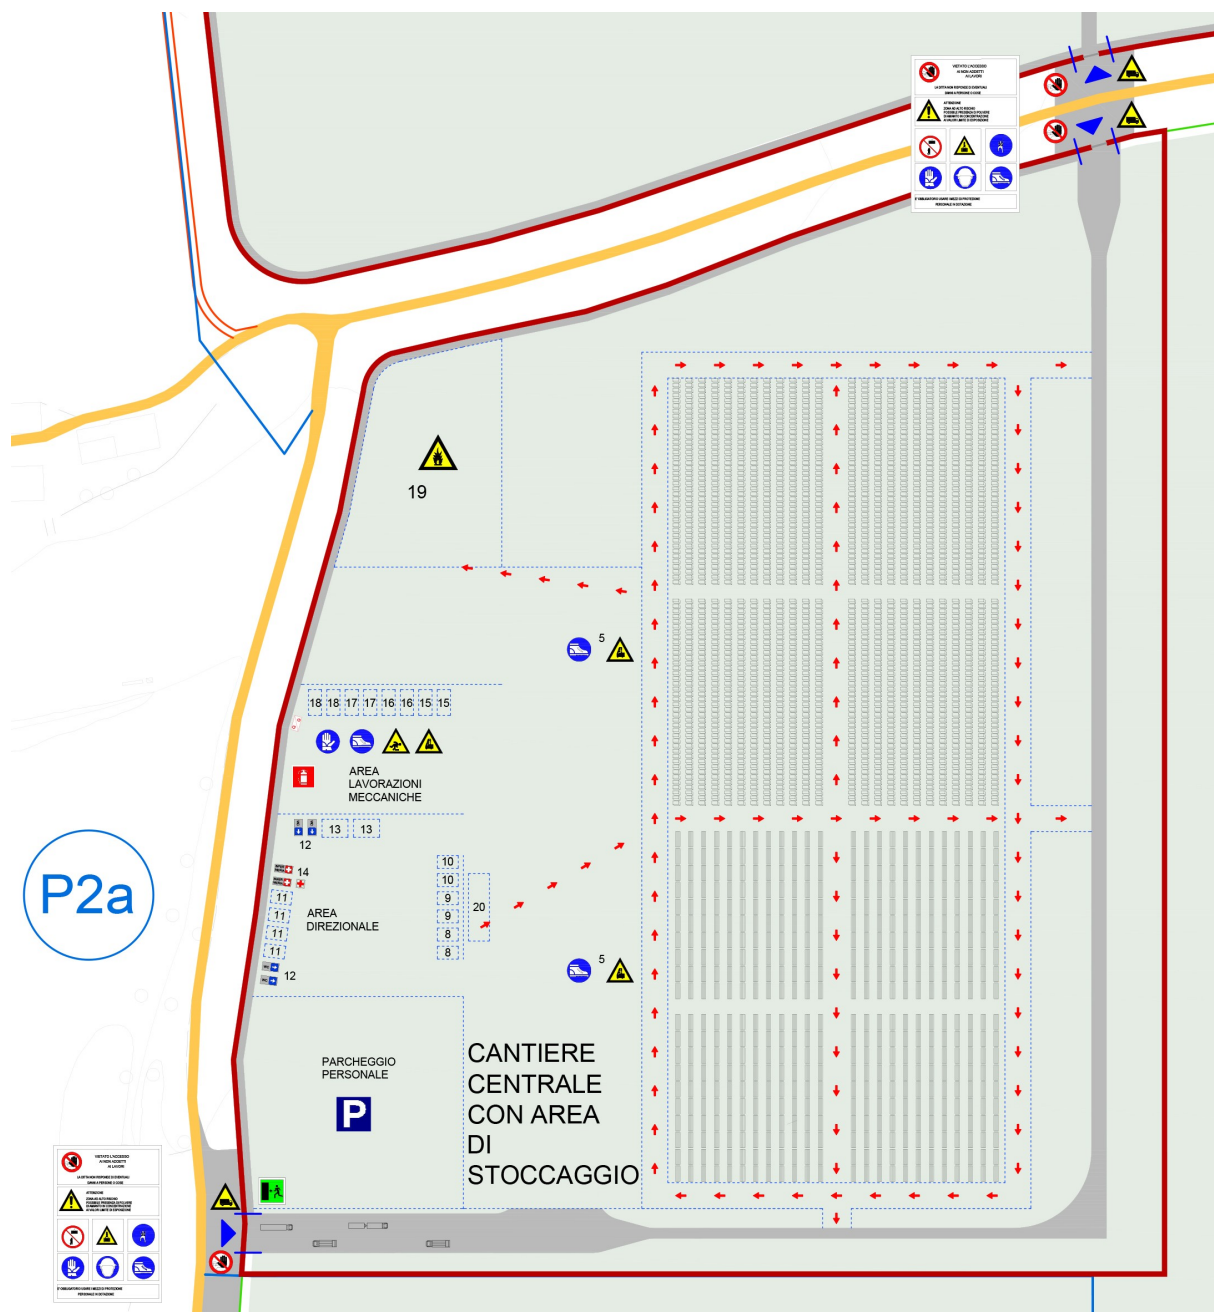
Fase di ricezione, stoccaggio e movimentazione materiali, dettaglio apprestamenti piastra 2a (cantiere 1)
